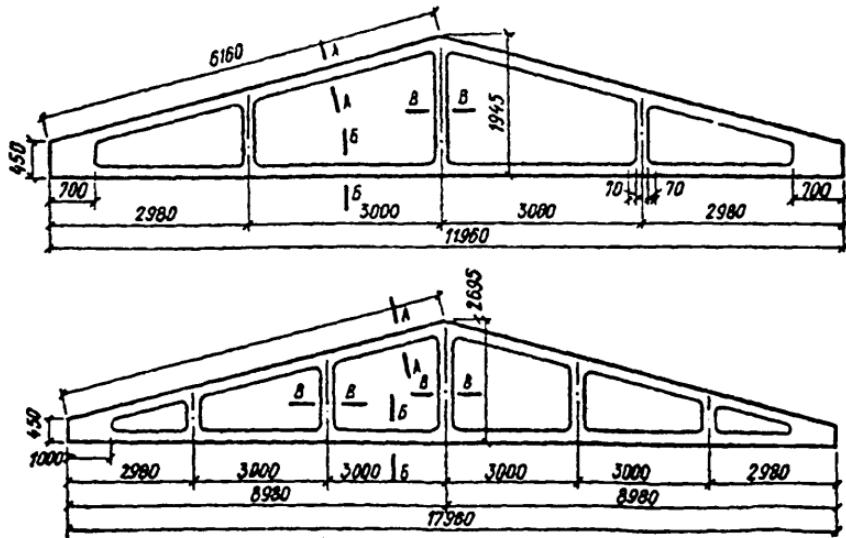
Сборные железобетонные безраскосные треугольные фермы пролетами 12 и 18 м
